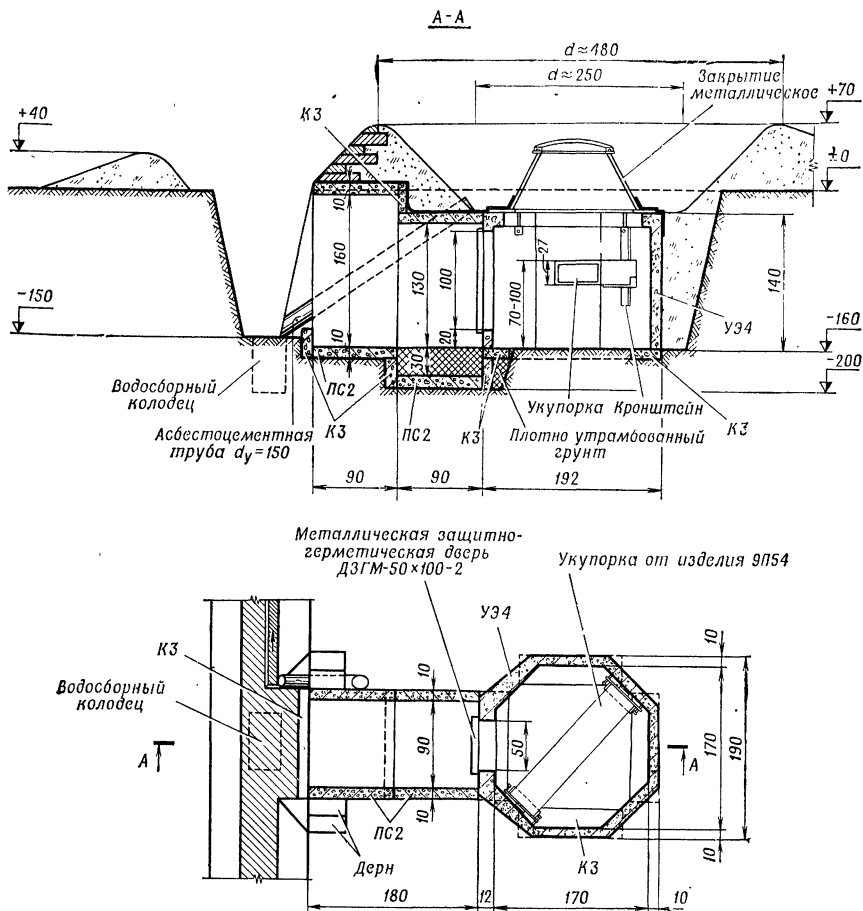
Сборное железобетонное пулеметное сооружение СПС-4 (план, разрез)
